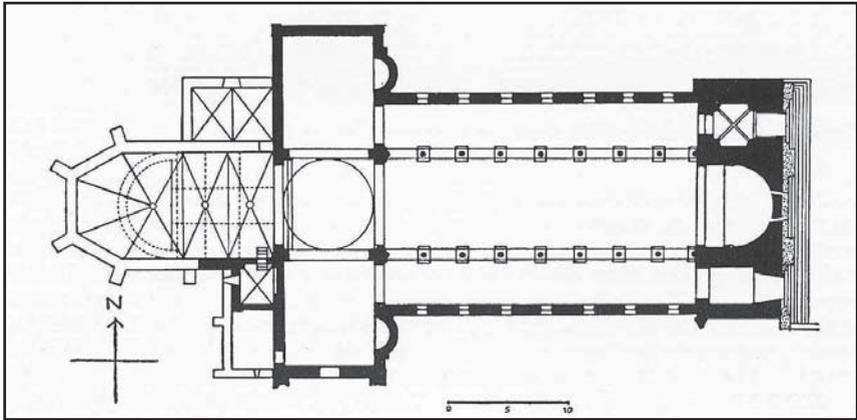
Bamberg, ehemalige Kollegiatstiftskirche St. Jakob. Grundriss (1065 begonnen, Westchor 15. Jahrhundert).
